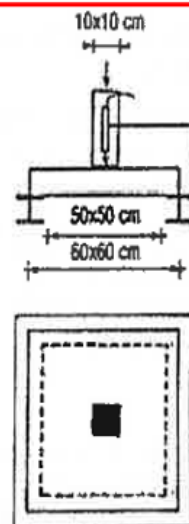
Essai de poinçonnement-flexion sur dalle.
